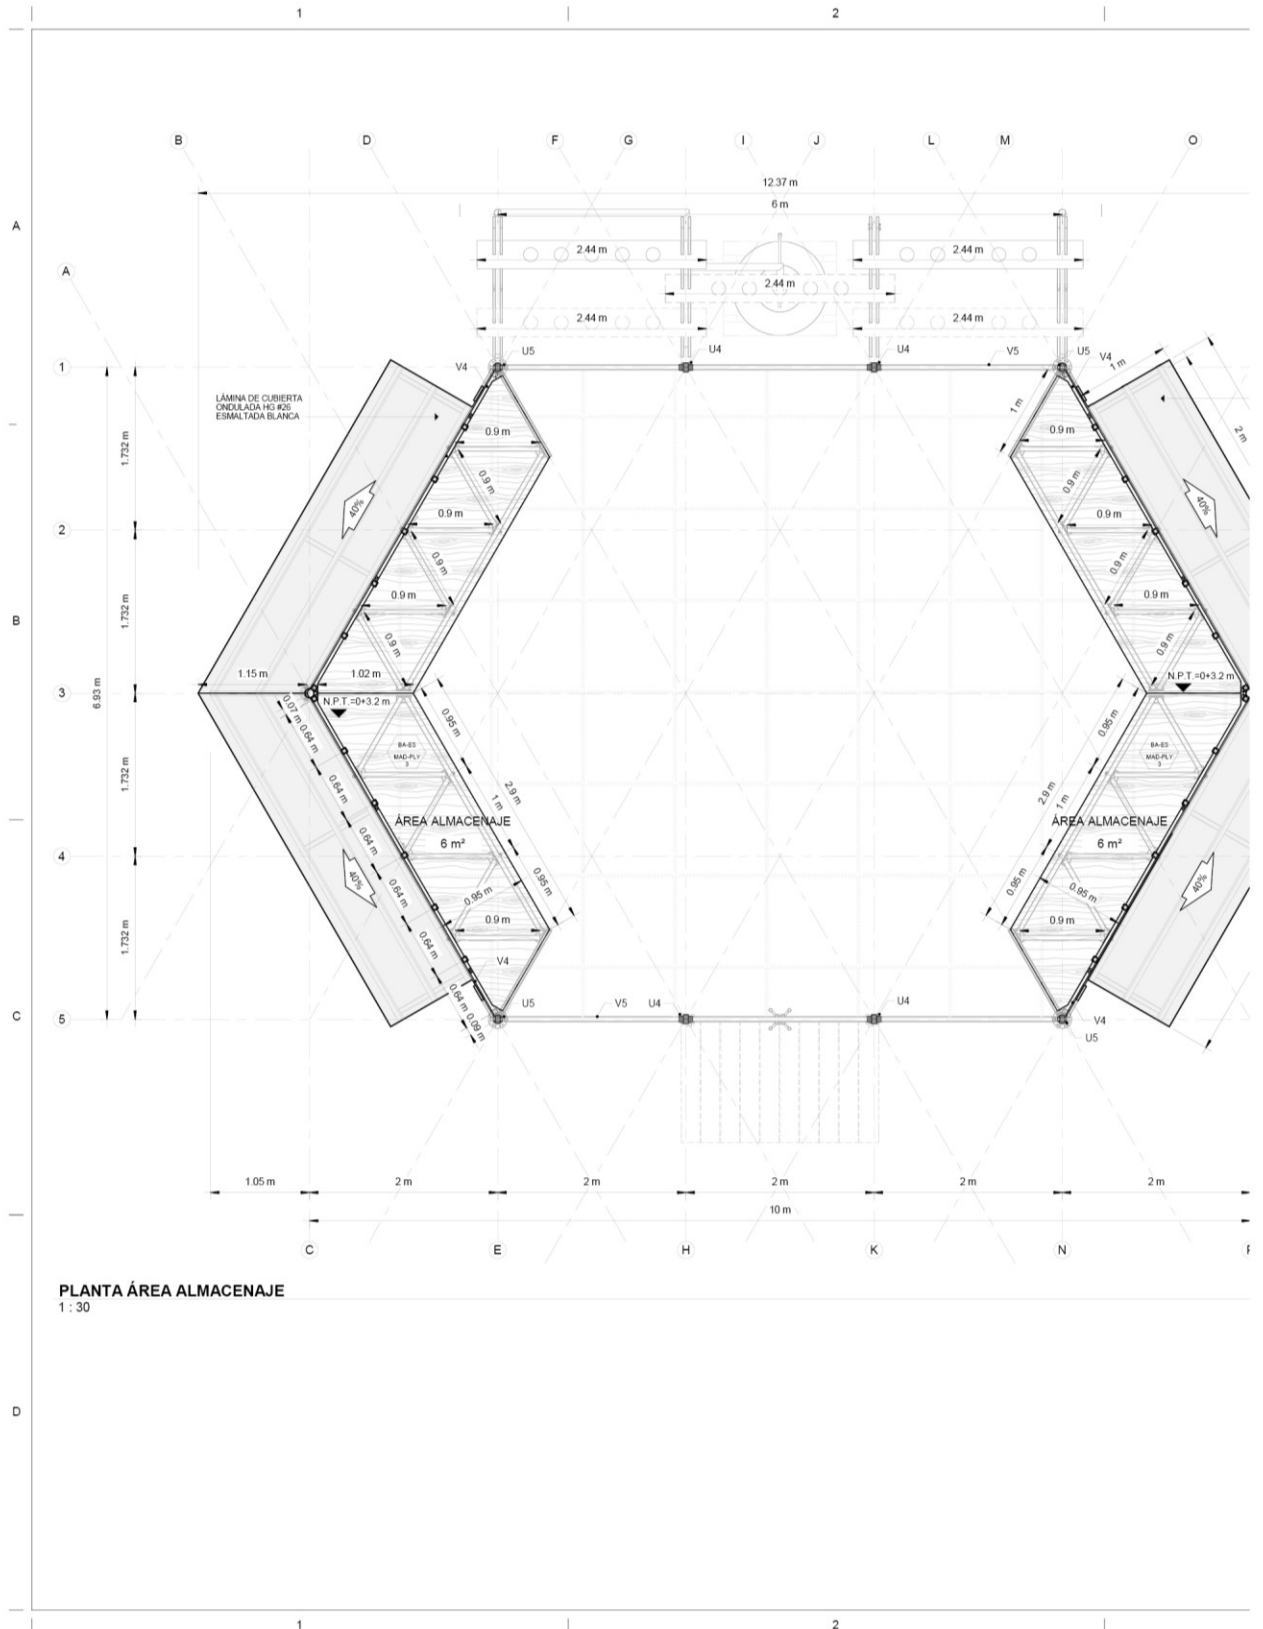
Lámina 05, planimetría de tipología B.<sup>314</sup>
